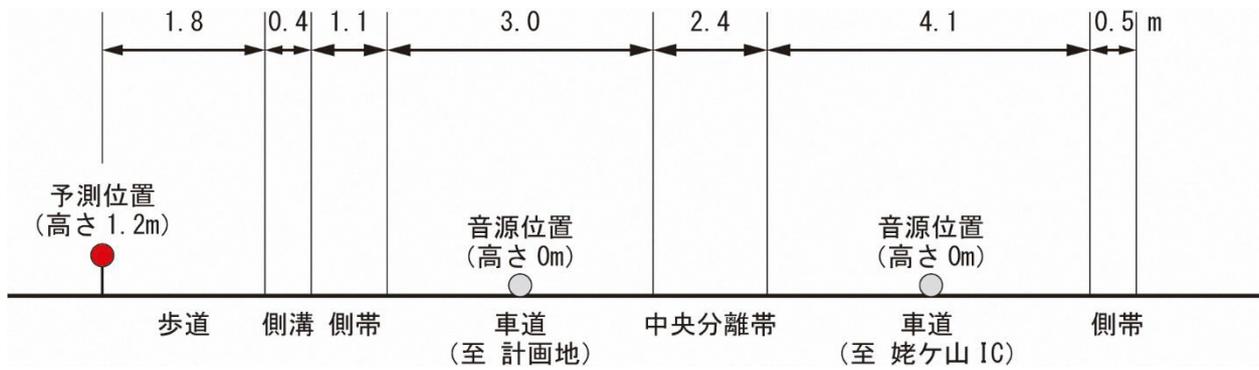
(4) 道路断面図 (東新潟病院前 : 嘉瀬蔵岡線沿道)
